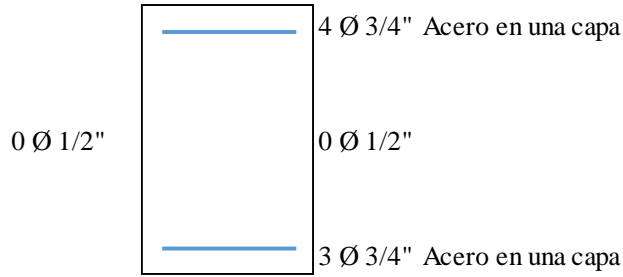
Distribución del Acero longitudinal de VP-103 (30 x 60) - Sistema estructural tradicional.
